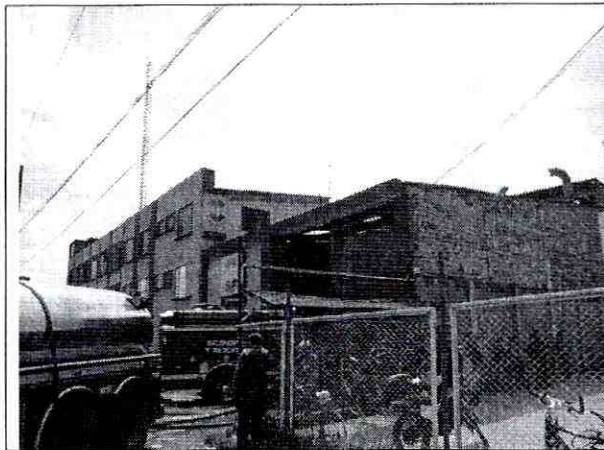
Vista general la fachada del edificio localizado en la Carrera 116 No. 17-20, donde se presentó el incendio.
